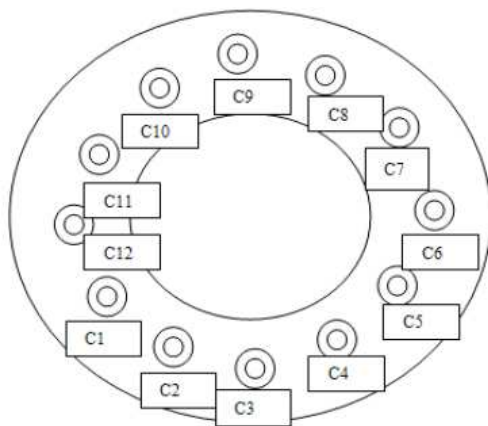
Locação de cordoalhas e aplicação de carga
